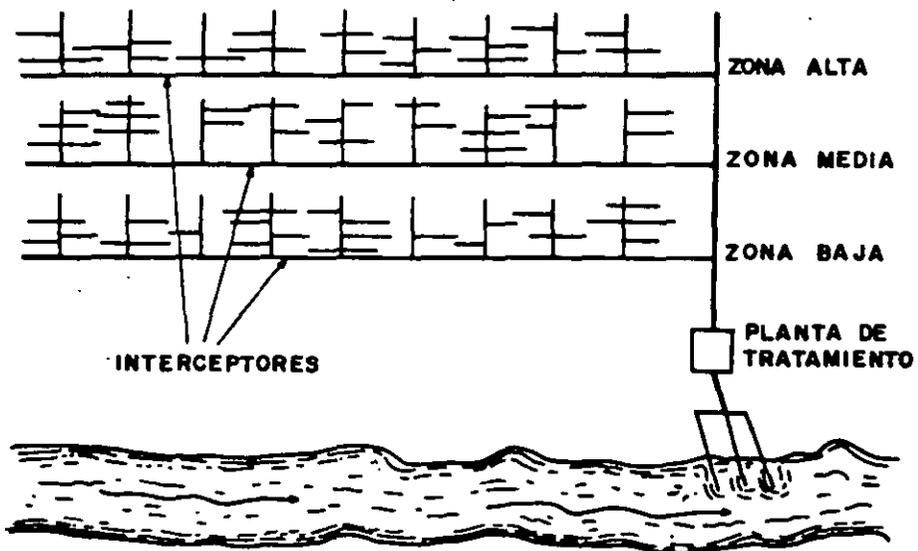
Conductos interceptores en un sistema de alcantarillado
